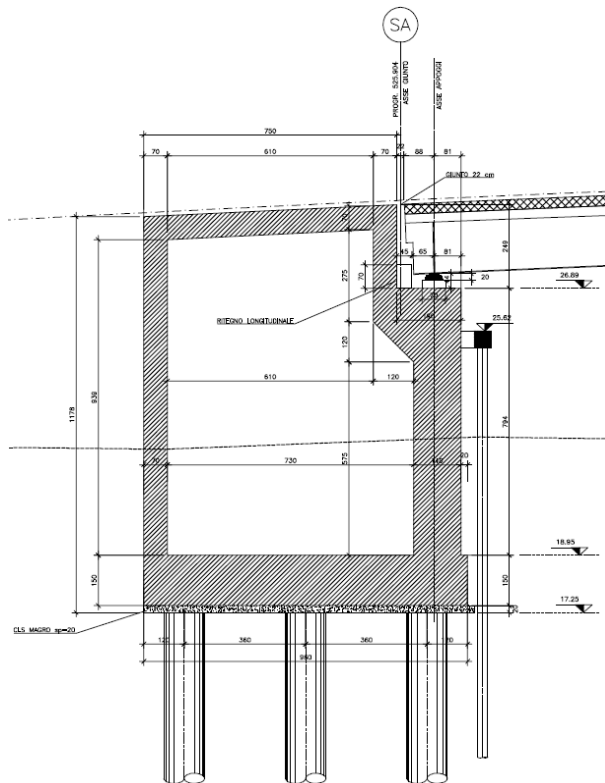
Sezione longitudinale - Spalla A
